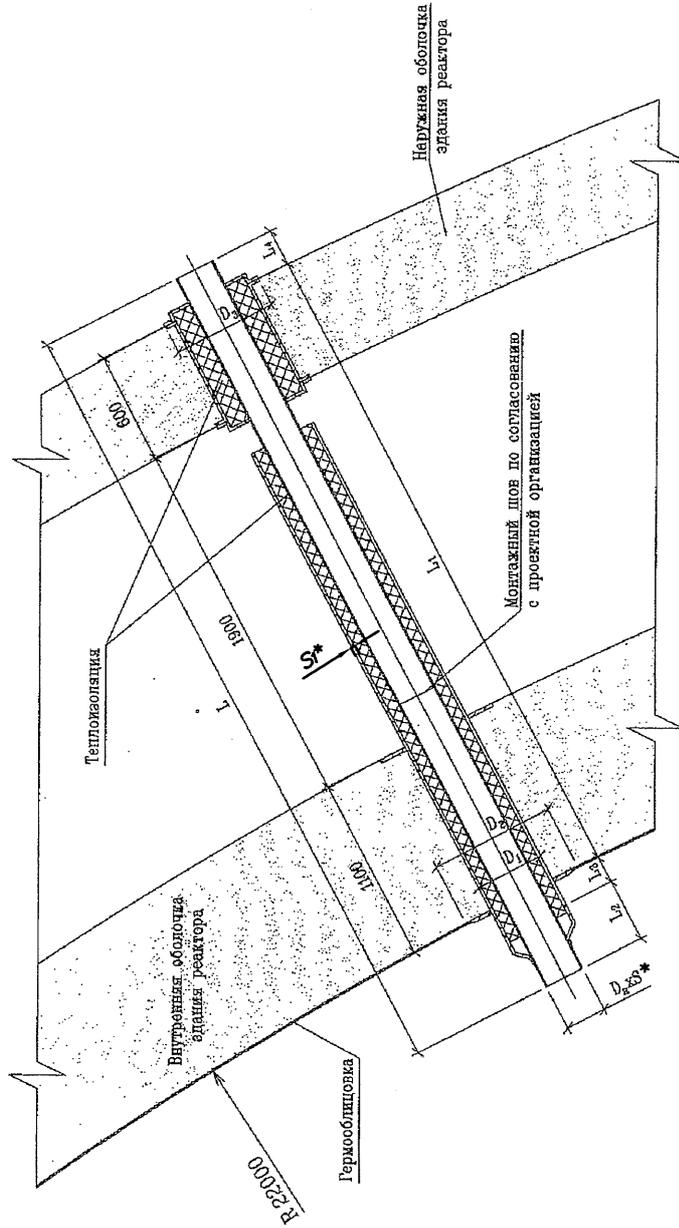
Габаритный чертёж герметичной проходки
